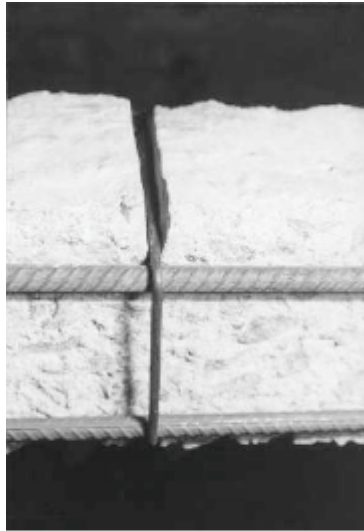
Detalhe do estribo (sulcos) e das armaduras longitudinais.
